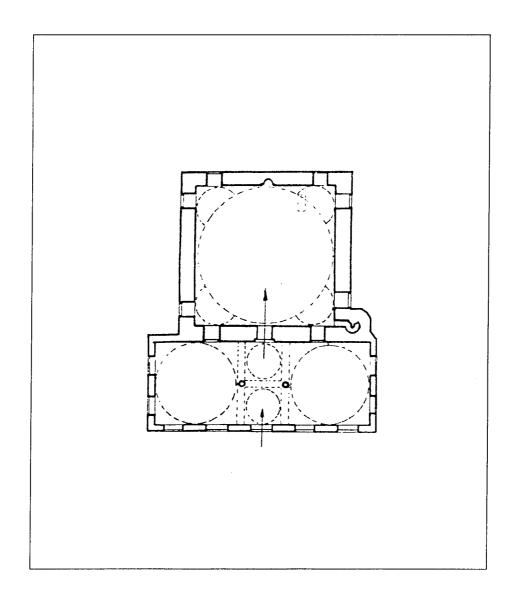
مسقط أفقي لمسجد اورطه فيStrumica (عن : كيل) .
